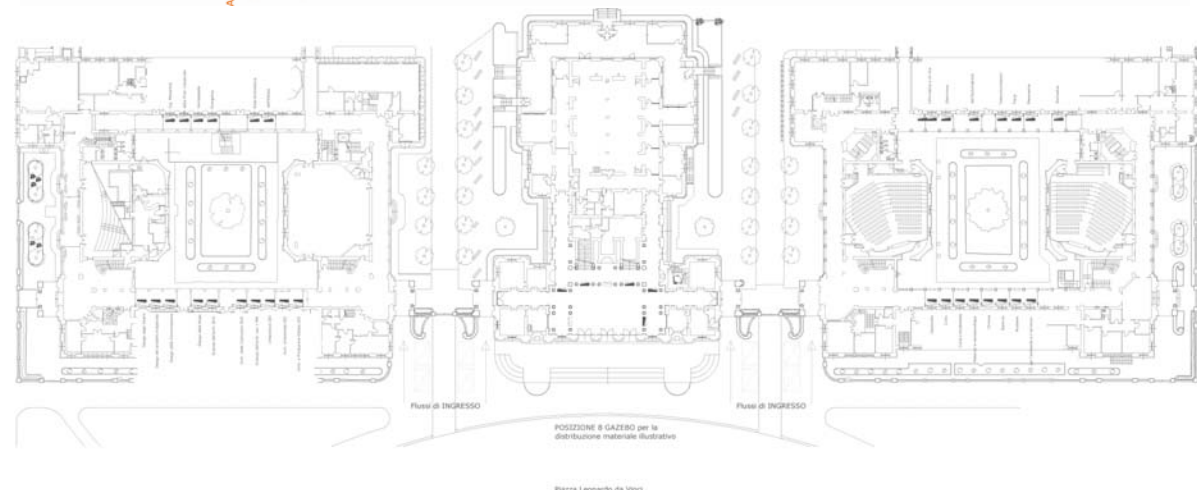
Pianta tecnica-esecutiva del progetto (sotto)
